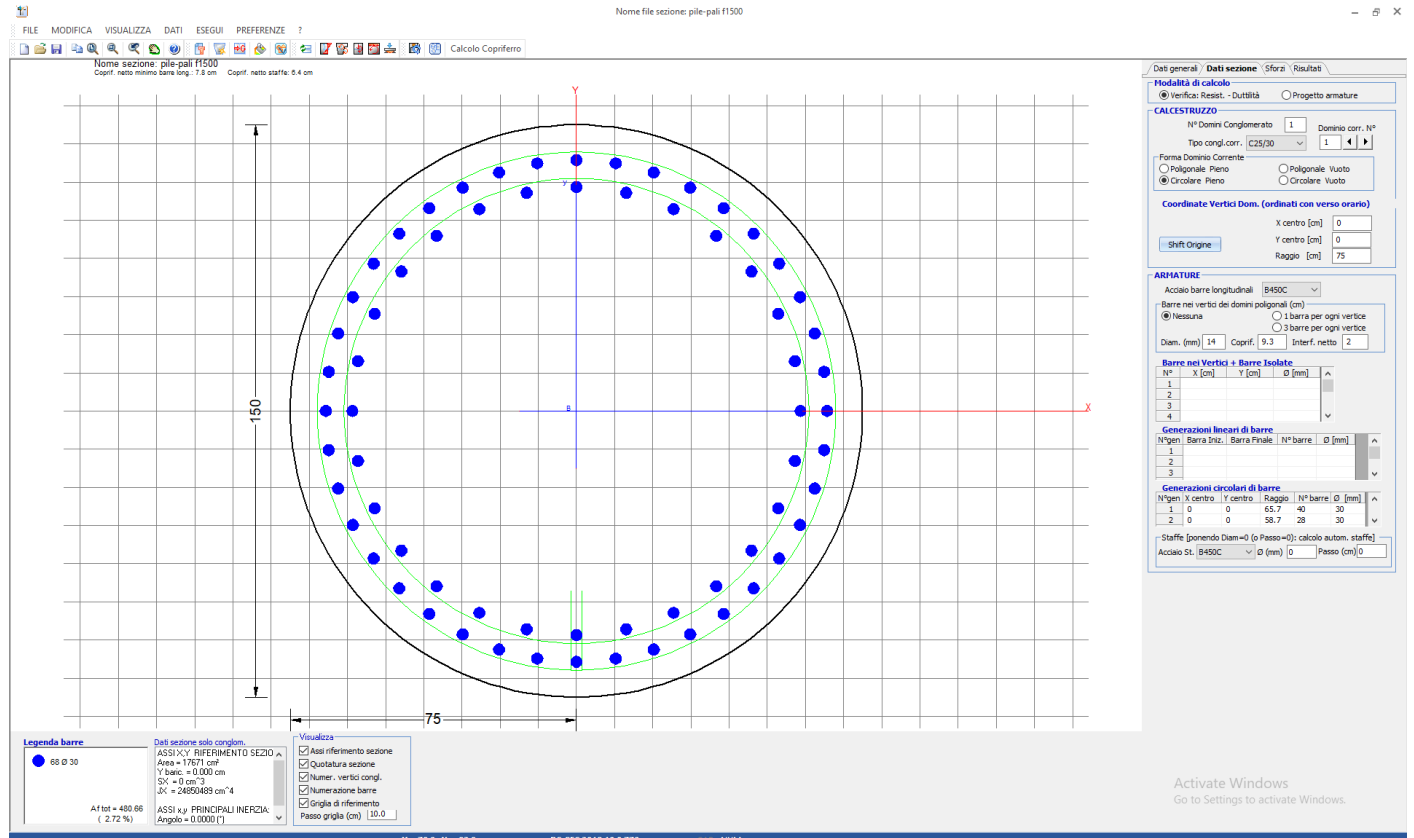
Pali di fondazione – Geometria sezione di verifica
